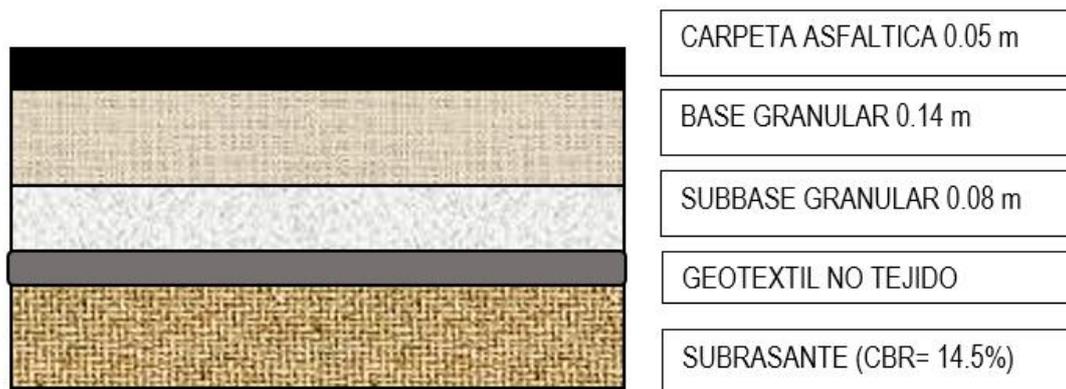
Diseño de pavimento flexible con geotextil no tejido
